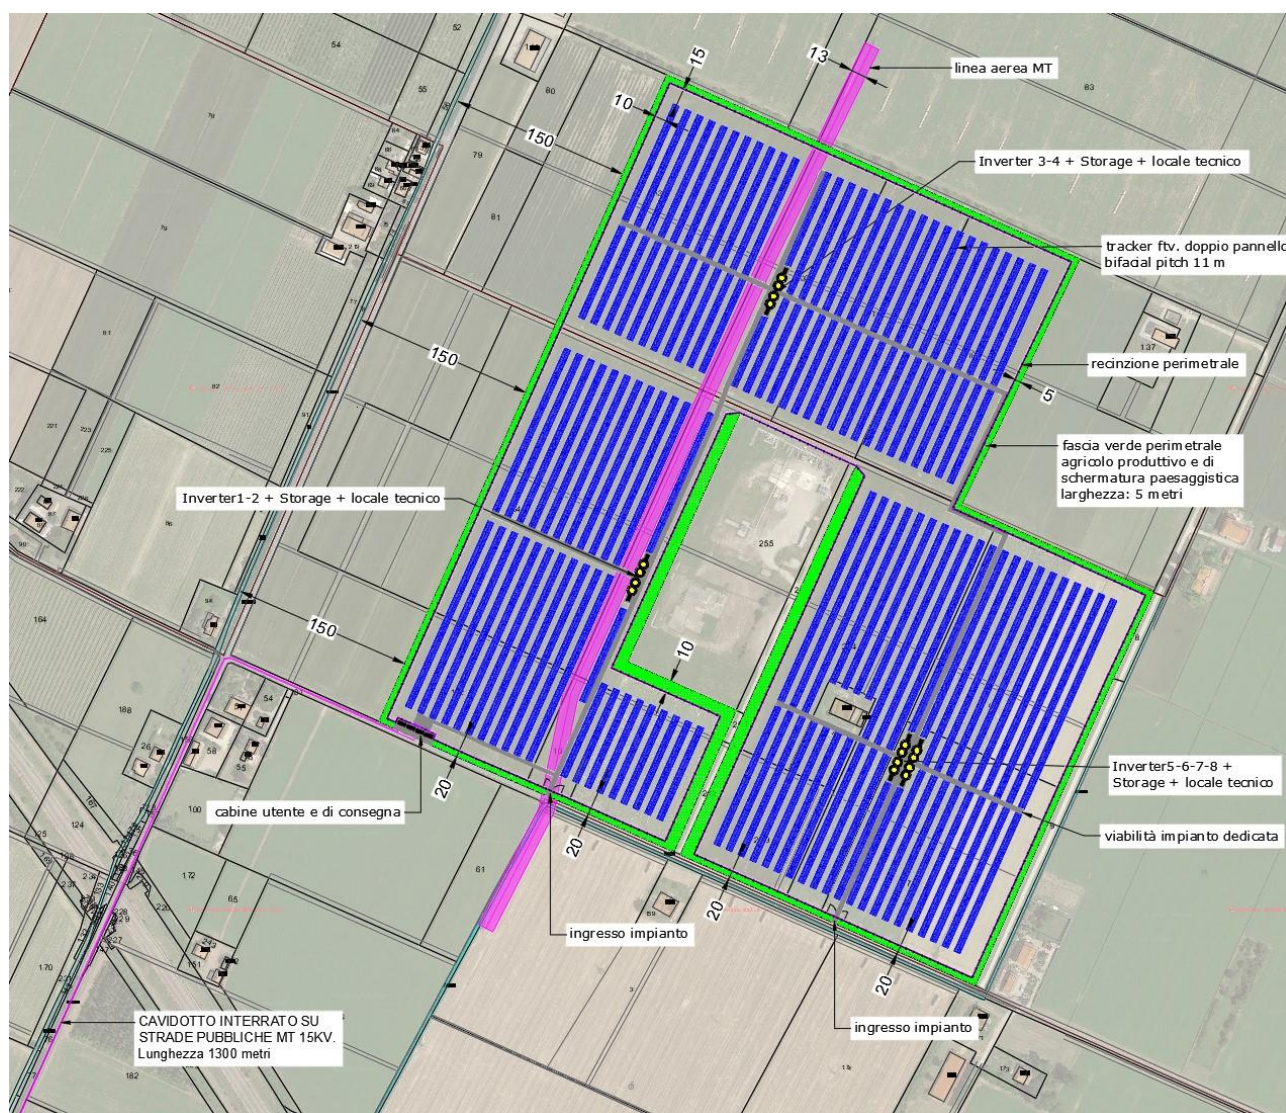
Layout impianto con rappresentata fascia rispetto linea aerea MT
